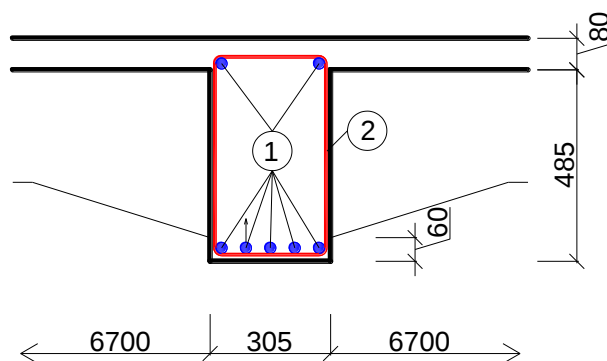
Detail sekané sondy u spodního líce průvlaku
